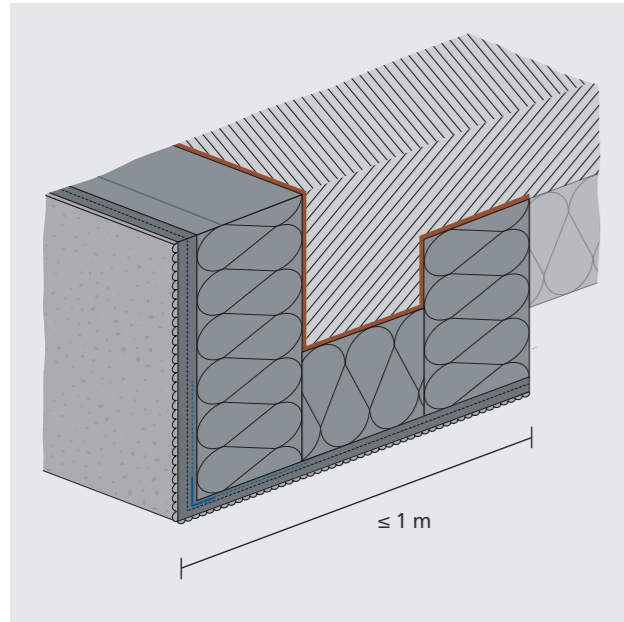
Umdämmter Unterzug mit horizontaler Dämmung
